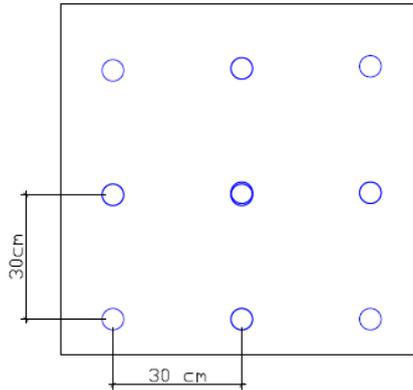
Detalhe em planta do posicionamento dos pinos de aderência para a implantação do pavimento sobre o paralelepípedo pré-existente.
